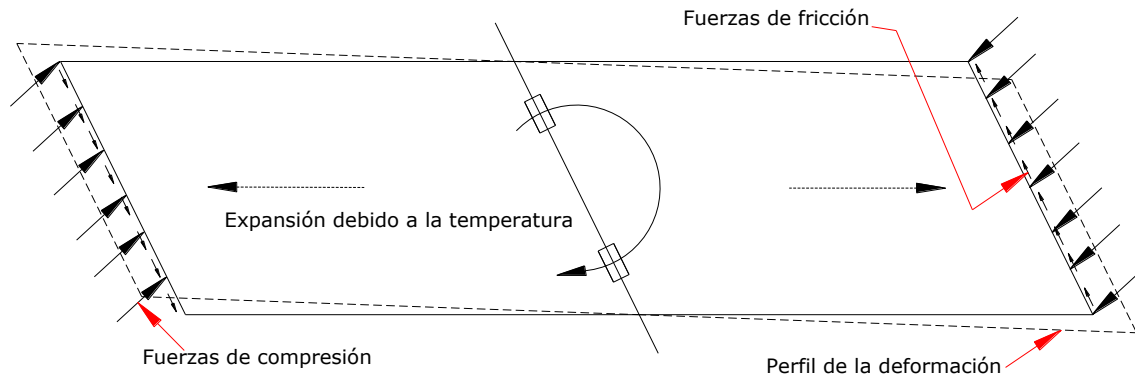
Expansión en una losa y comportamiento rotacional de torsión en el puente.
